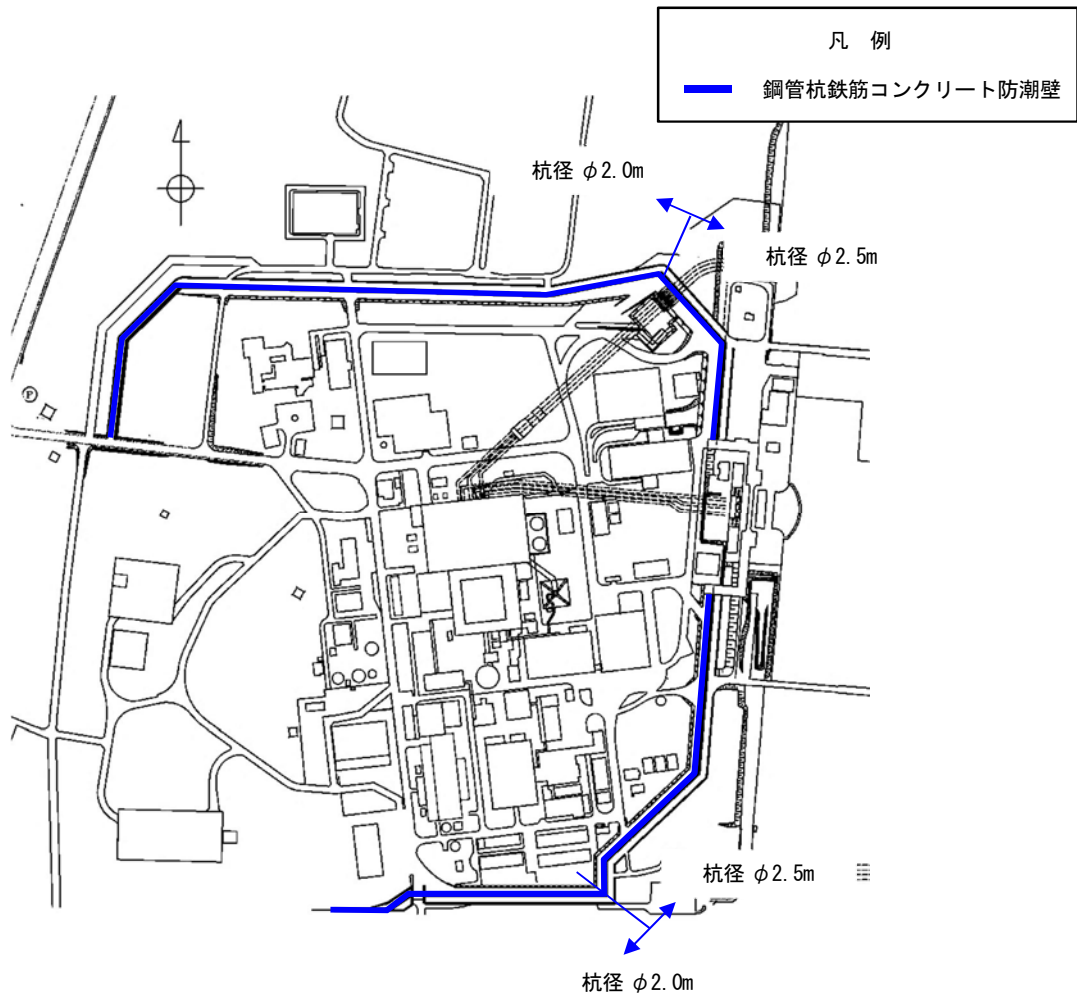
鋼管杭鉄筋コンクリート防潮壁の平面配置図
